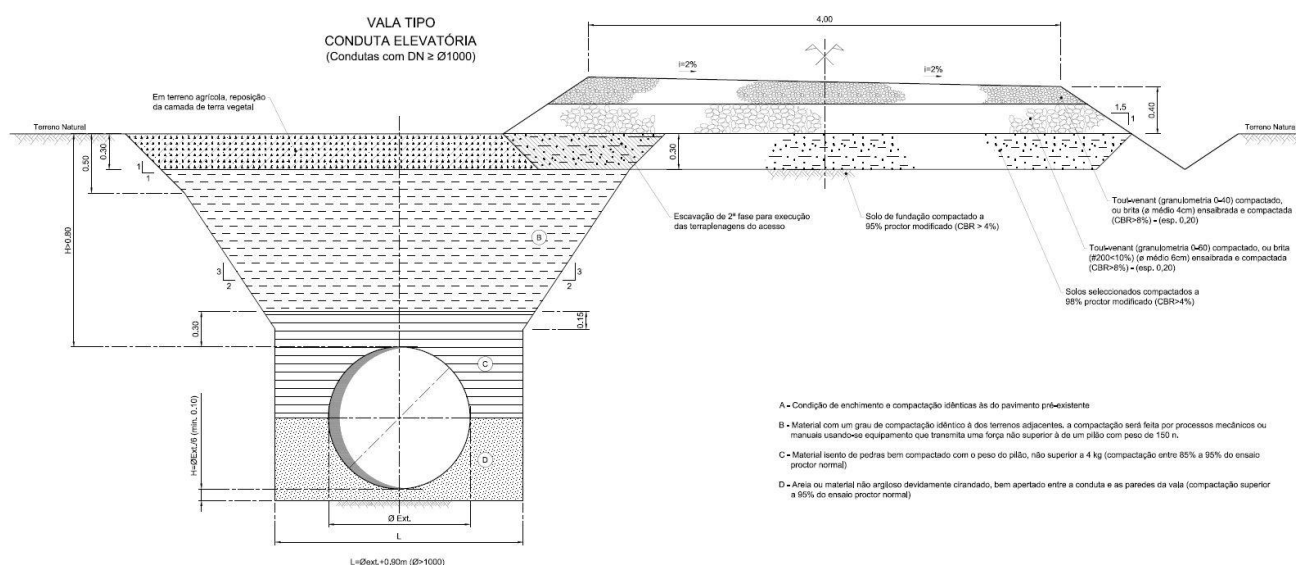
Conduta elevatória. Caminho com plataforma melhorada. Perfil tipo.
